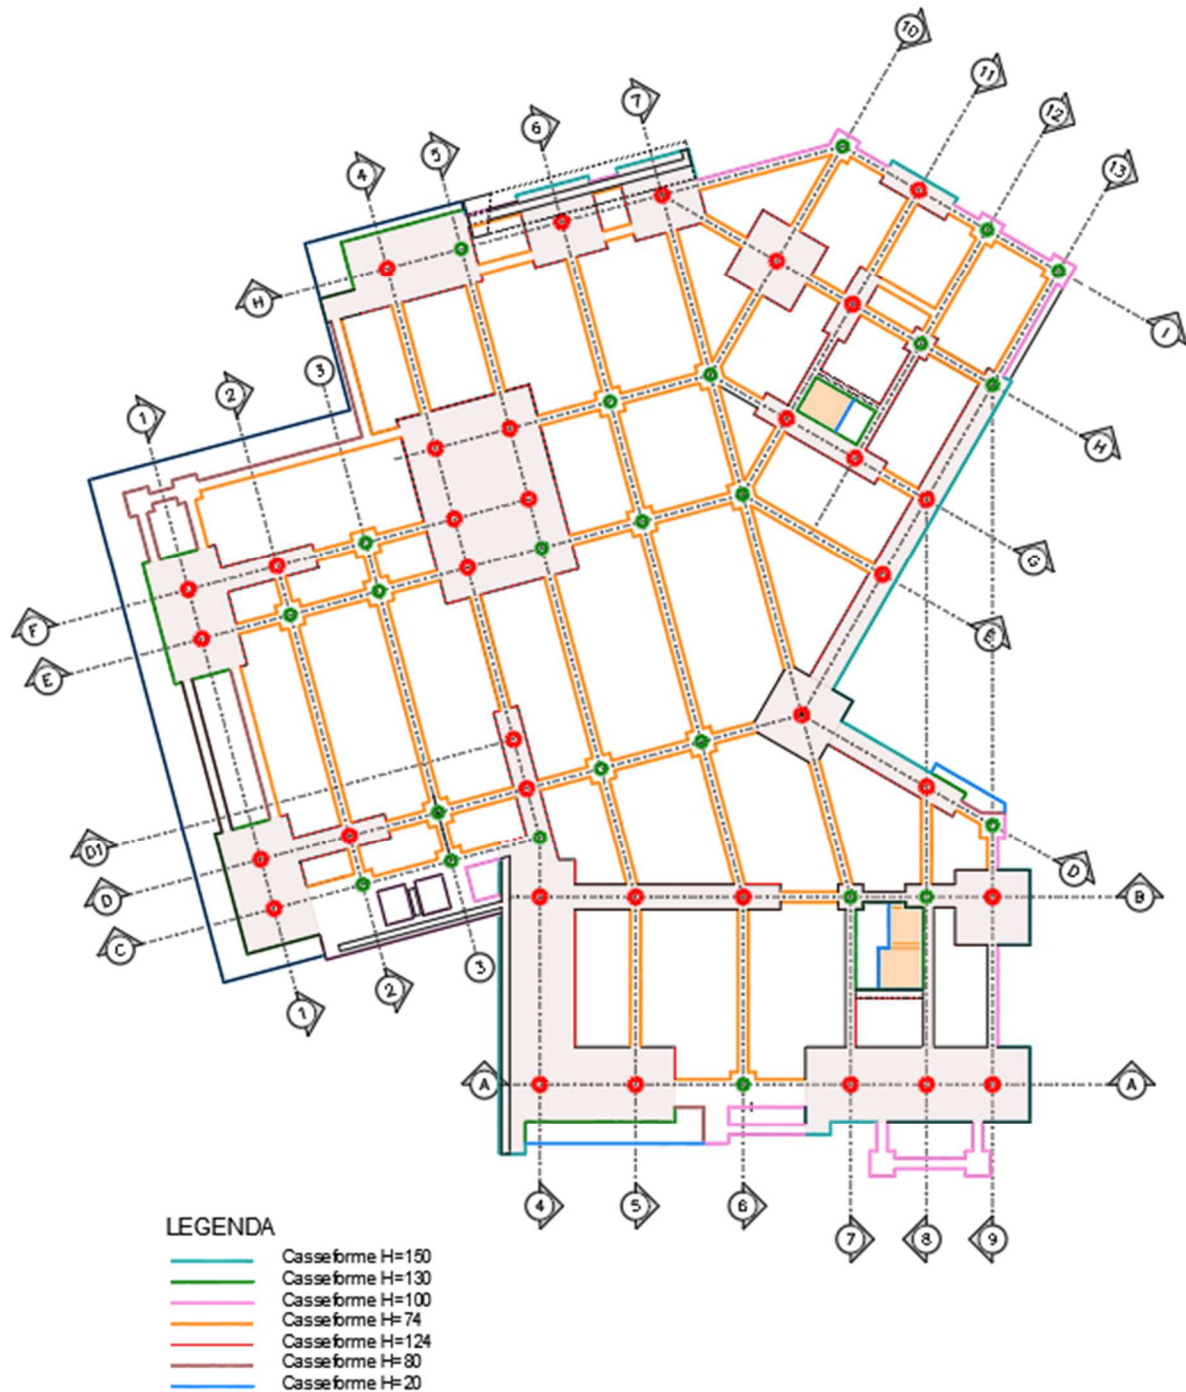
Piano fondazione: sviluppo lineare dei casseri delle opere di fondazione
